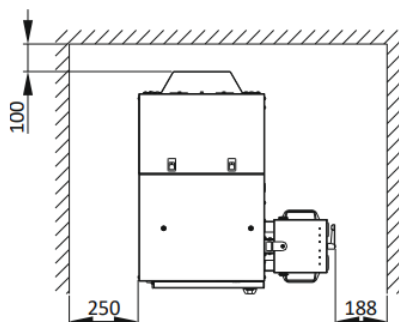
Planta acotada das separacións mínimas da caldeira. Fonte: Ecoforest.
